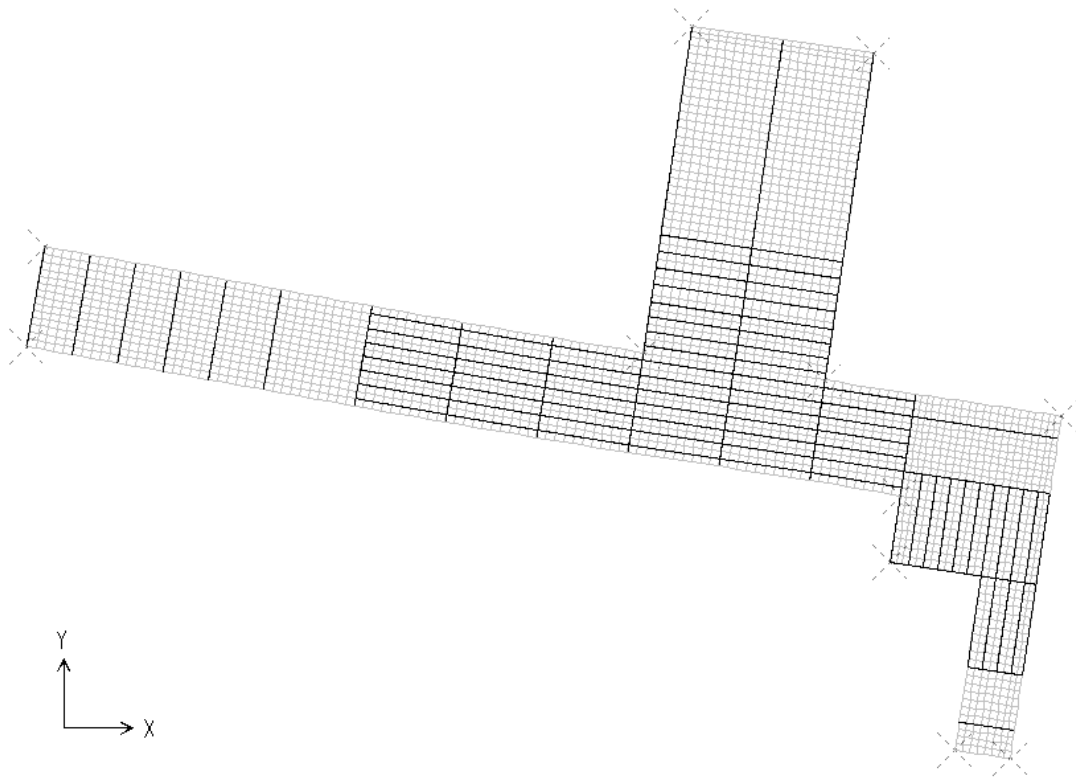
Configuração Deformada – Planta – Amarração –Projeto Executivo
